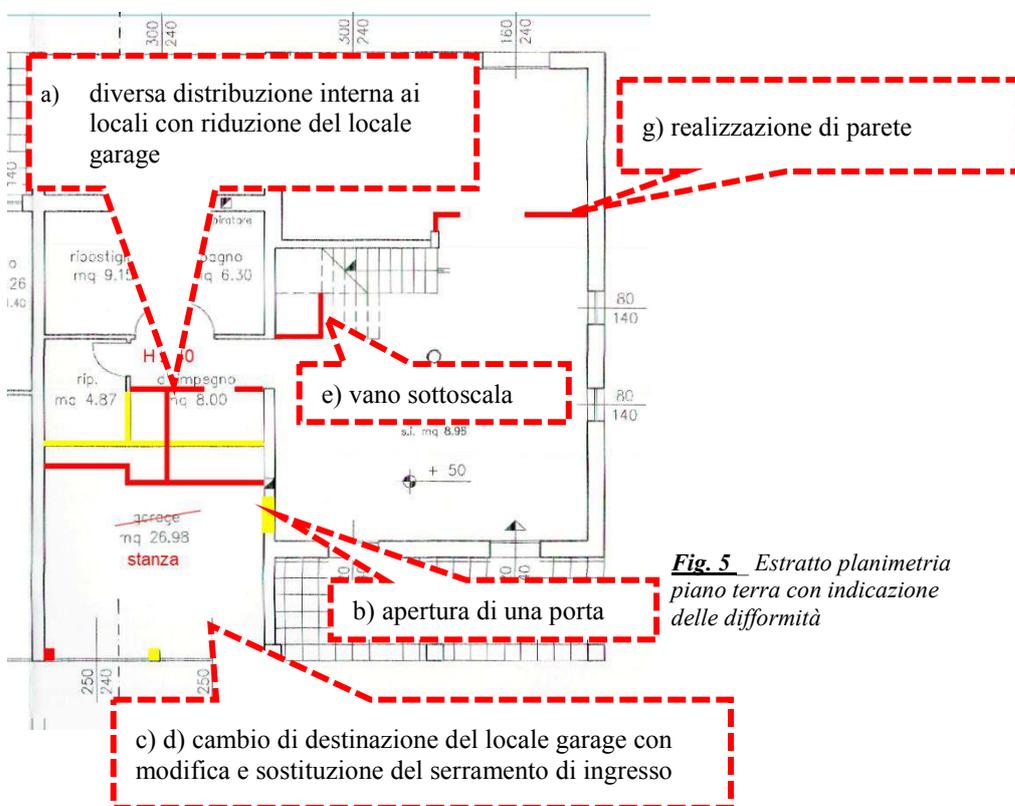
Estratto planimetria piano terra con indicazione delle difformità
